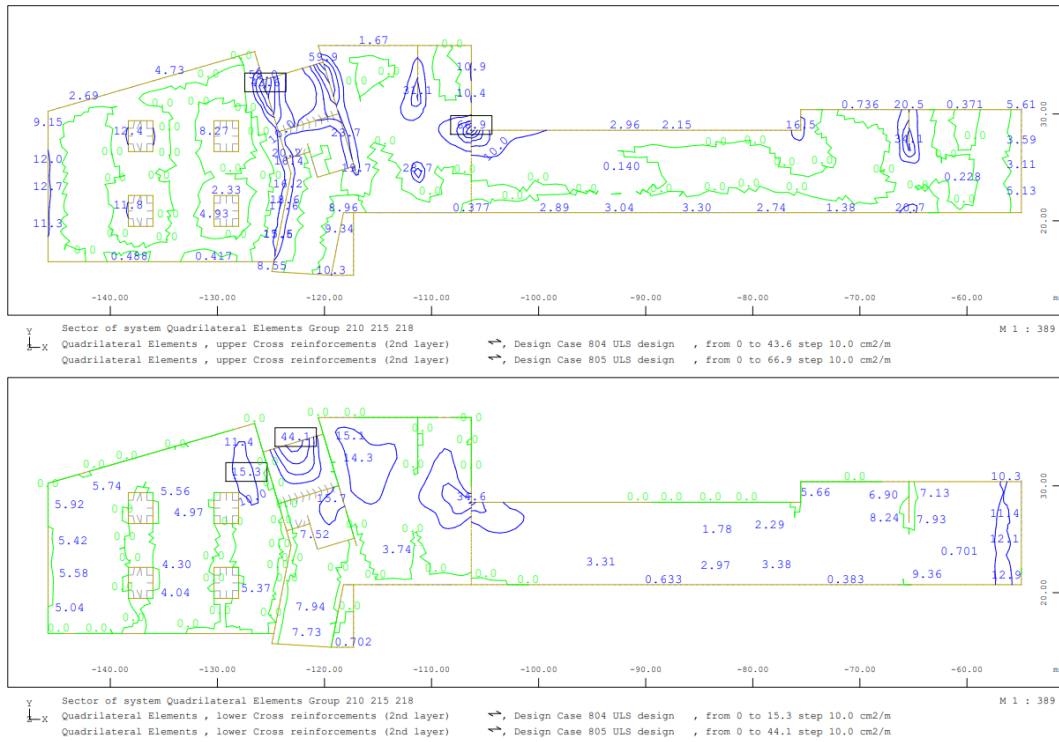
Armadura secundária na face inferior (sup.) e superior (inf.) – laje de fundação – acesso Norte - ELU
